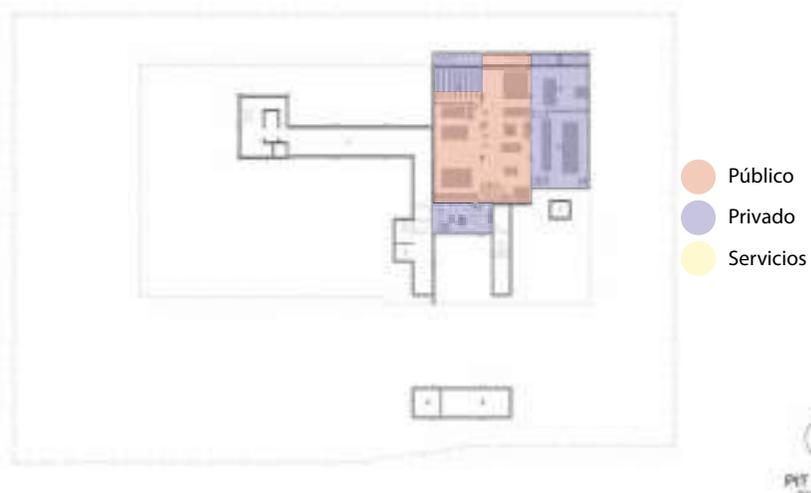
Planta Arquitectónica Sótano - Design Strategy & Research Center. Plano de THE_SYSTEM LAB (Plataforma Arquitectura, 2017)
